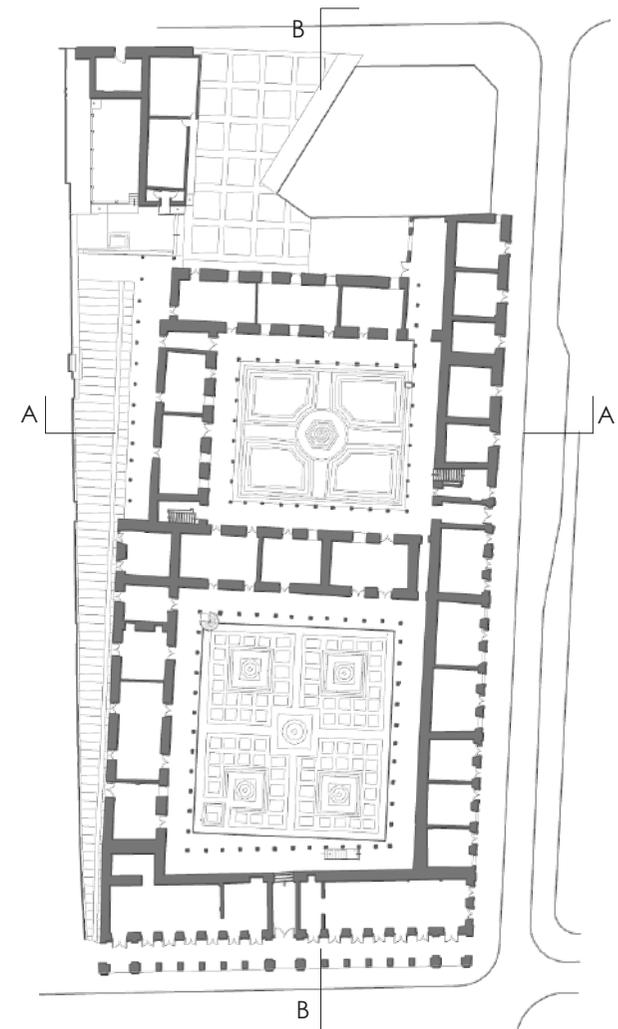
Planta Baja del Seminario San Luis desde el año 2017- 2020
